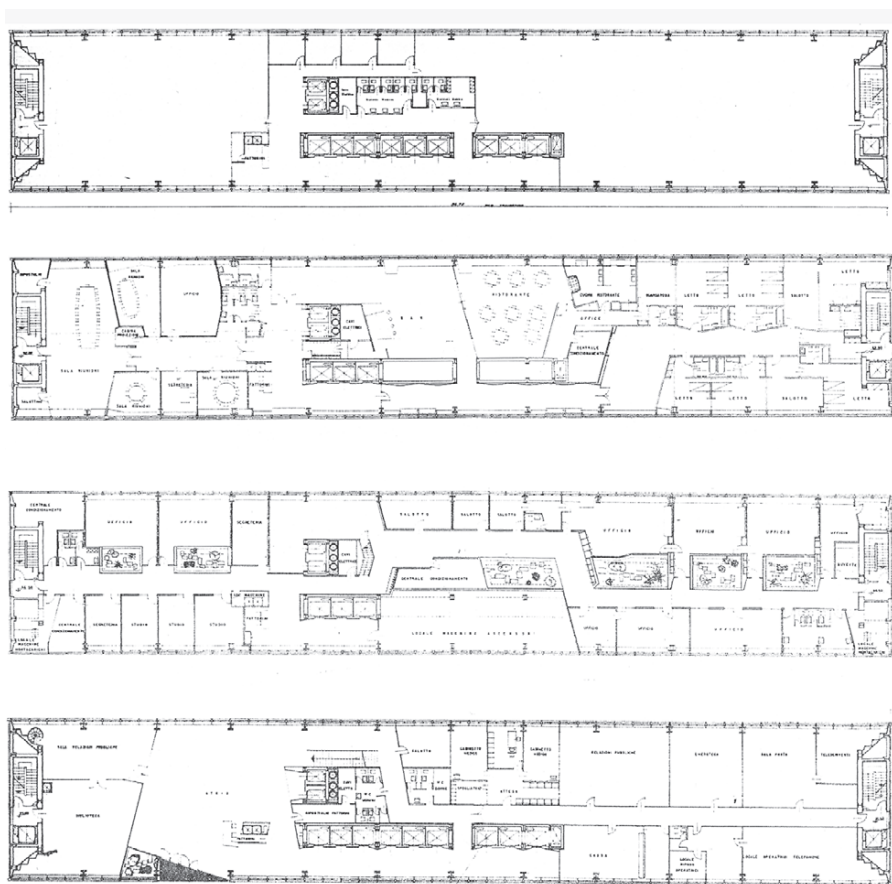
Dall'alto, pianta del piano terreno, del piano primo, del piano tipo, dei piani 19° e 20° (da Edilizia Moderna, n. 79, 1963)
